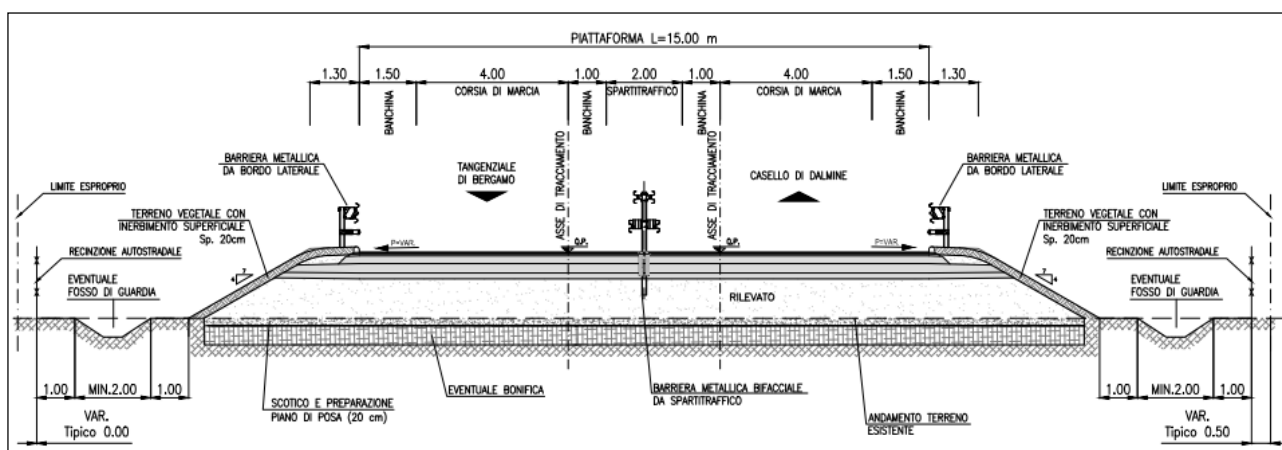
Sezione tipo rampa bidirezionale a 2 corsie
